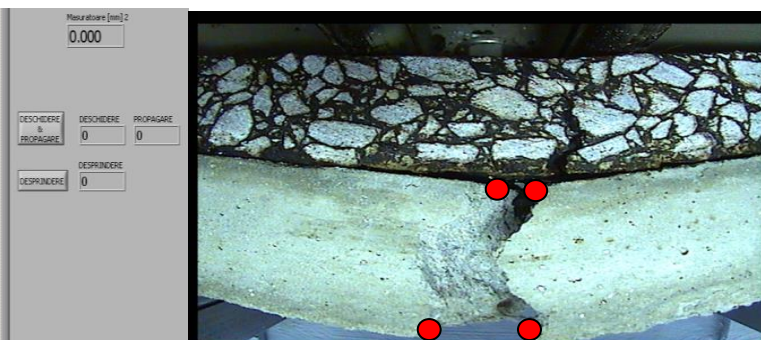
Dală fără conlucrare la fisura (db=7mm), crăpătură în dală
